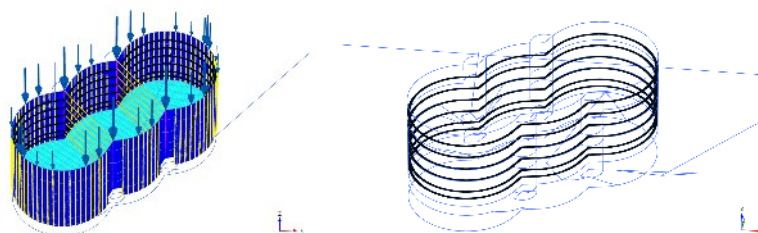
Geometria do modelo tridimensional de cálculo (PLAXIS 3D) – Elementos estruturais: parede de contenção, anéis, pórticos e laje de fundo
